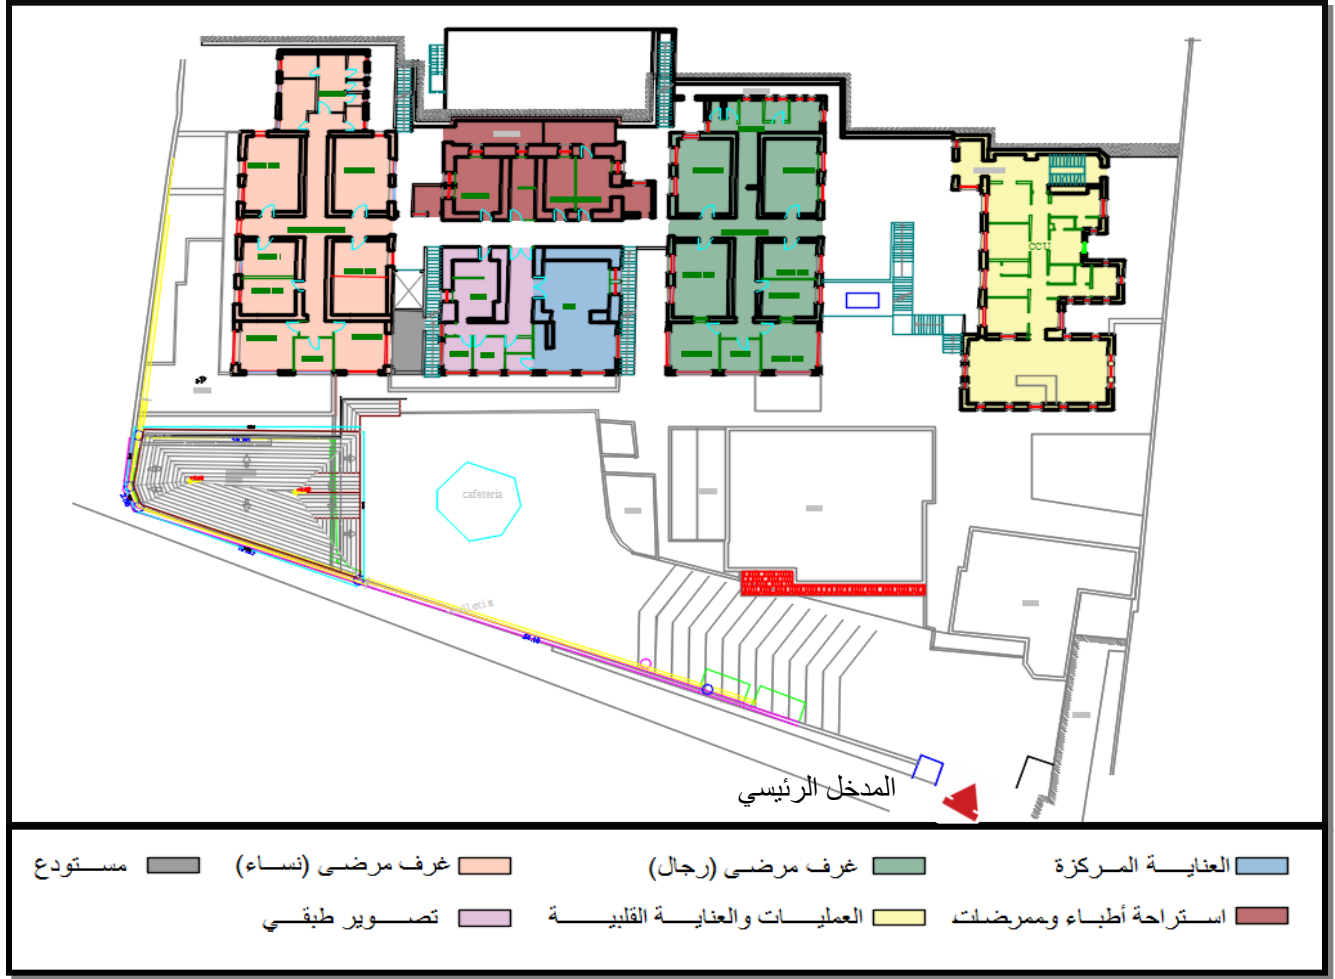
مسقط أفقي للطابق الأرضي.
